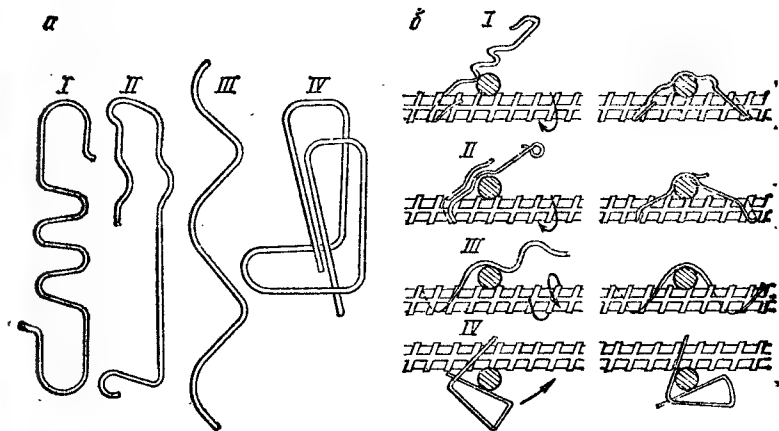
Фиксаторы для сварки арматурных каркасов
